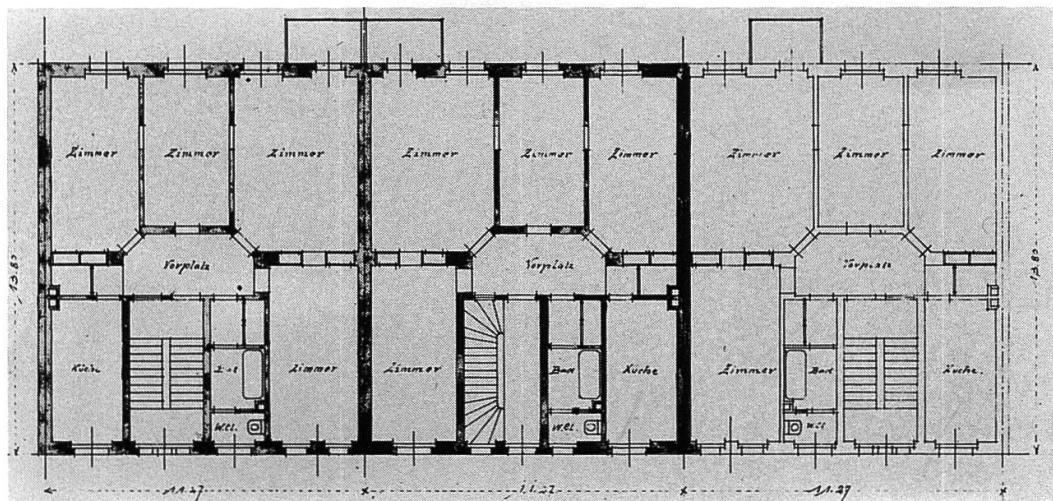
Eigerstrasse 44–50. Grundriss des 1. Obergeschosses von 1903.
